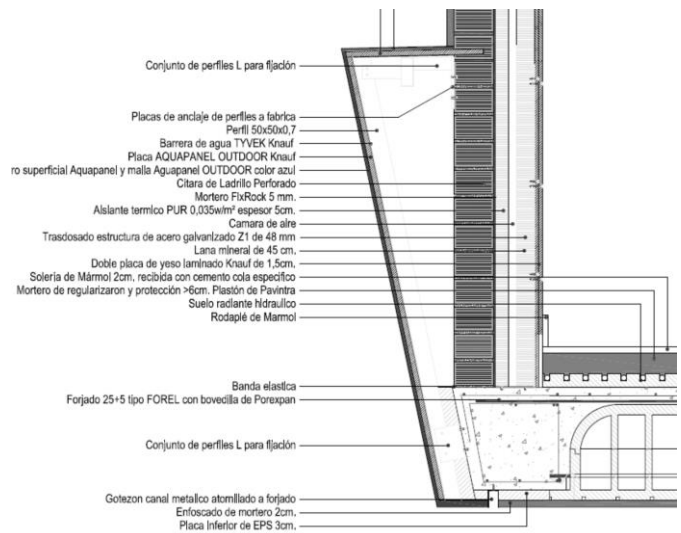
Detalle constructivo del proyecto con el sistema de fachada.
